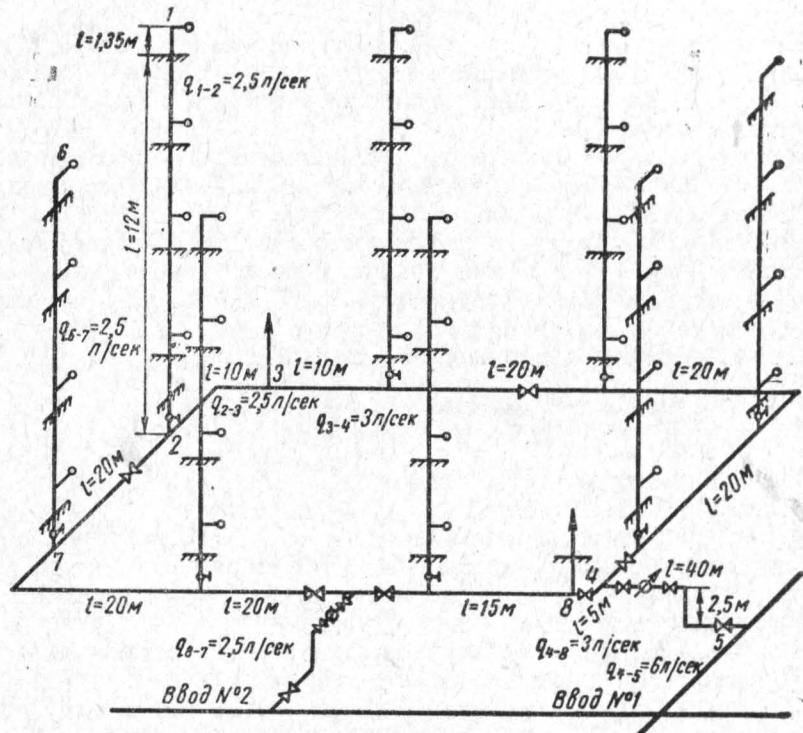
Схема внутренней водопроводной сети (к примеру расчета внутренней водопроводной сети).
